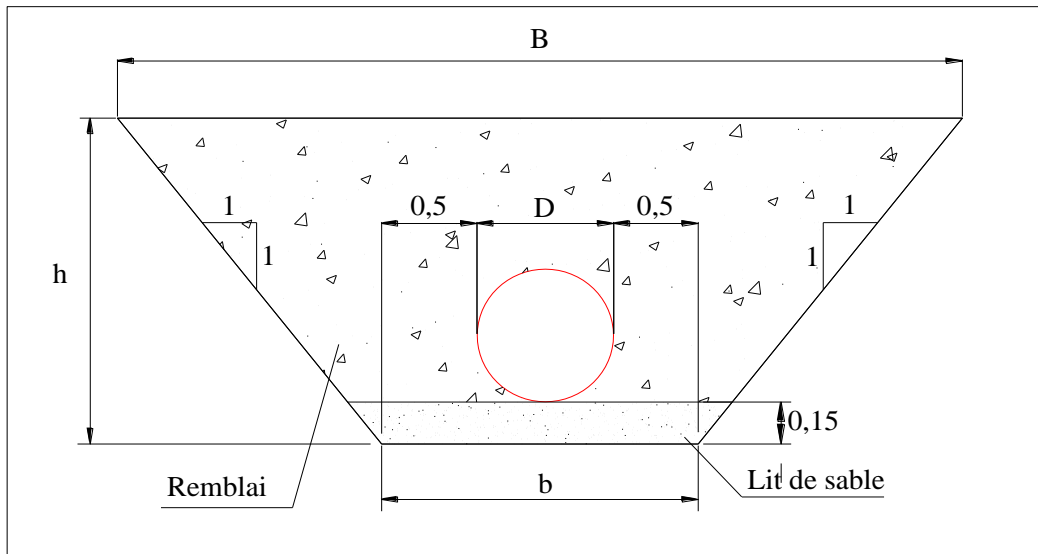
Coupes en travers de la tranchée de la conduite.
